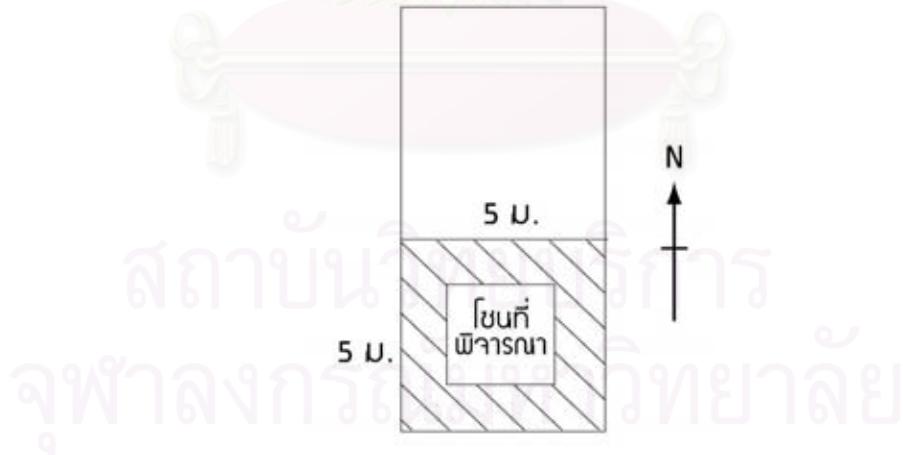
Floor Plan แสดงลักษณะของโฉนตัวอย่างที่ 2
